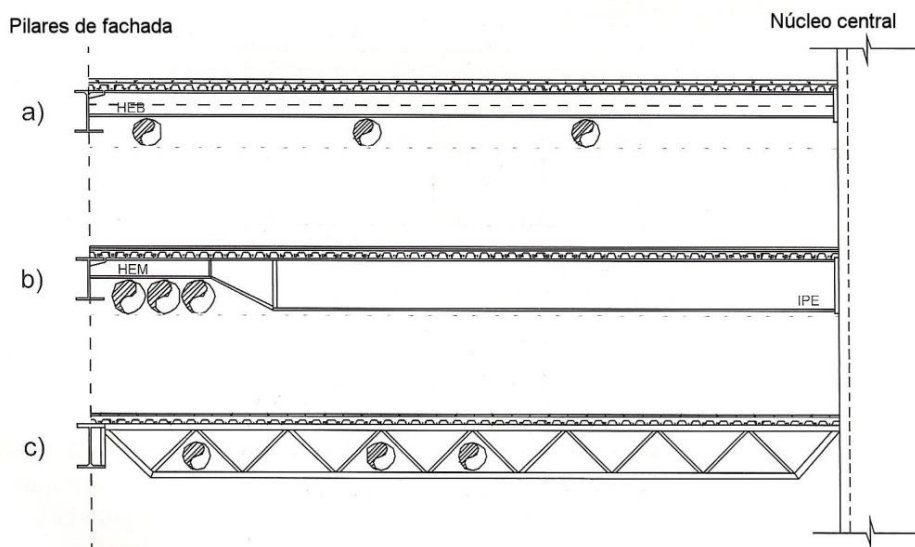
Relação entre vigas metálicas e instalações (Cruz, 2009)
